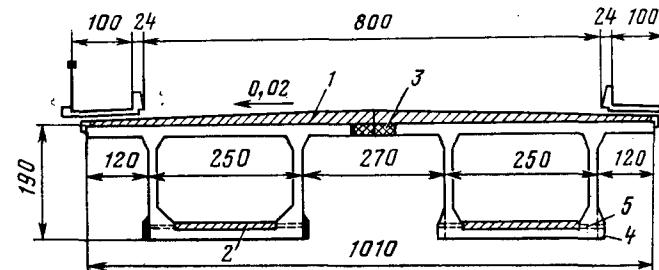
Разрез пролетного строения моста через р. Вента:
